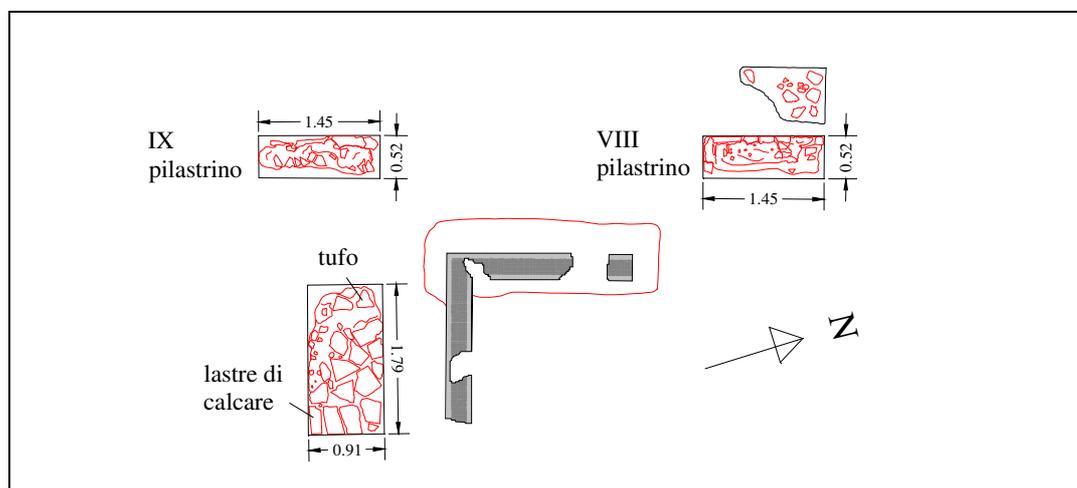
angolo sud/ovest pavimentazione in cementizio con cornice mosaicata, pianta di Alessandra Iodice.
